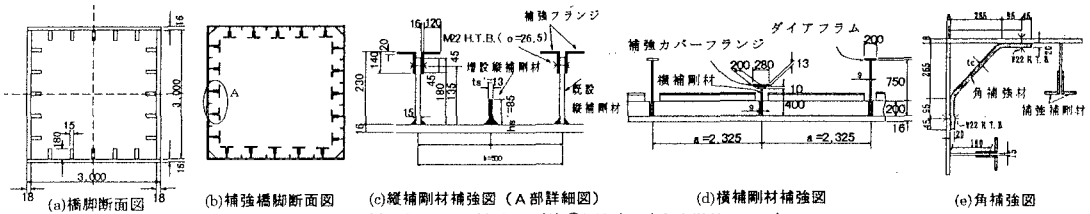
橋脚柱断面の補強図(第③断面)(寸法単位: mm)
